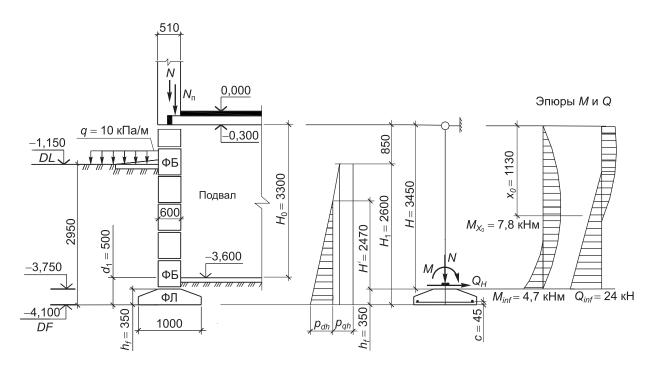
Расчетная схема и конструкция фундамента к примеру Г.6
